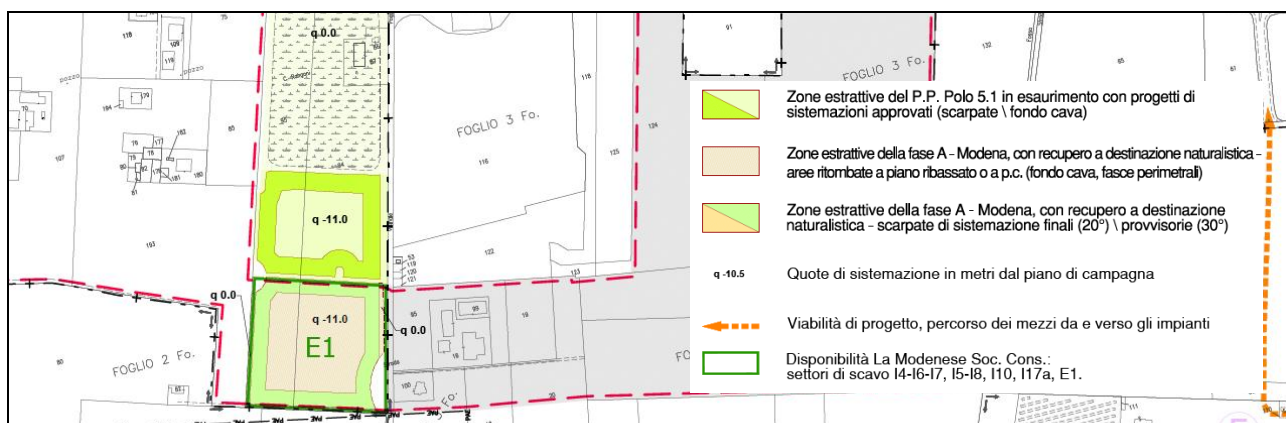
PC- Estratto da tavola 2.2.h "Progetto – Planimetria di sistemazione morfologica"
